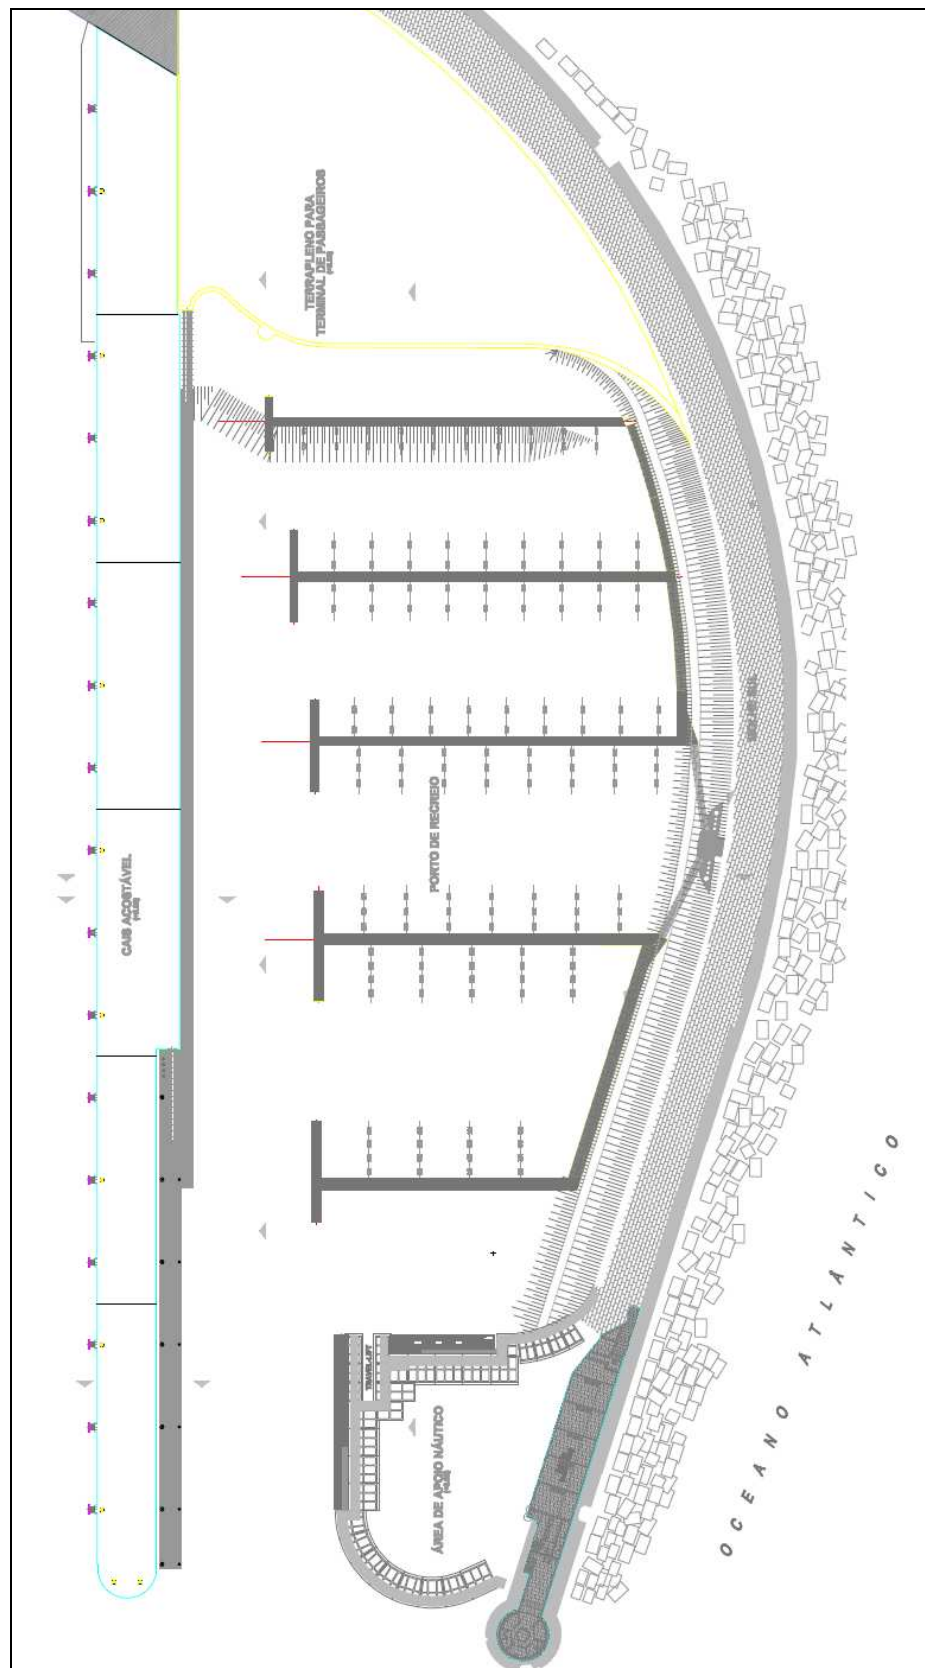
Planta do arranjo geral da obra (imagem do projecto de execução).
